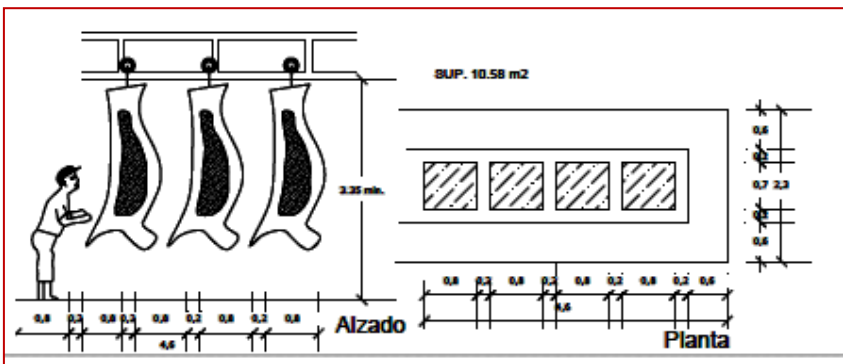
Planta y alzado cámara de refrigeración. Fuente. Pablo Enrique Herrera Gaona. 28 octubre 2014.
